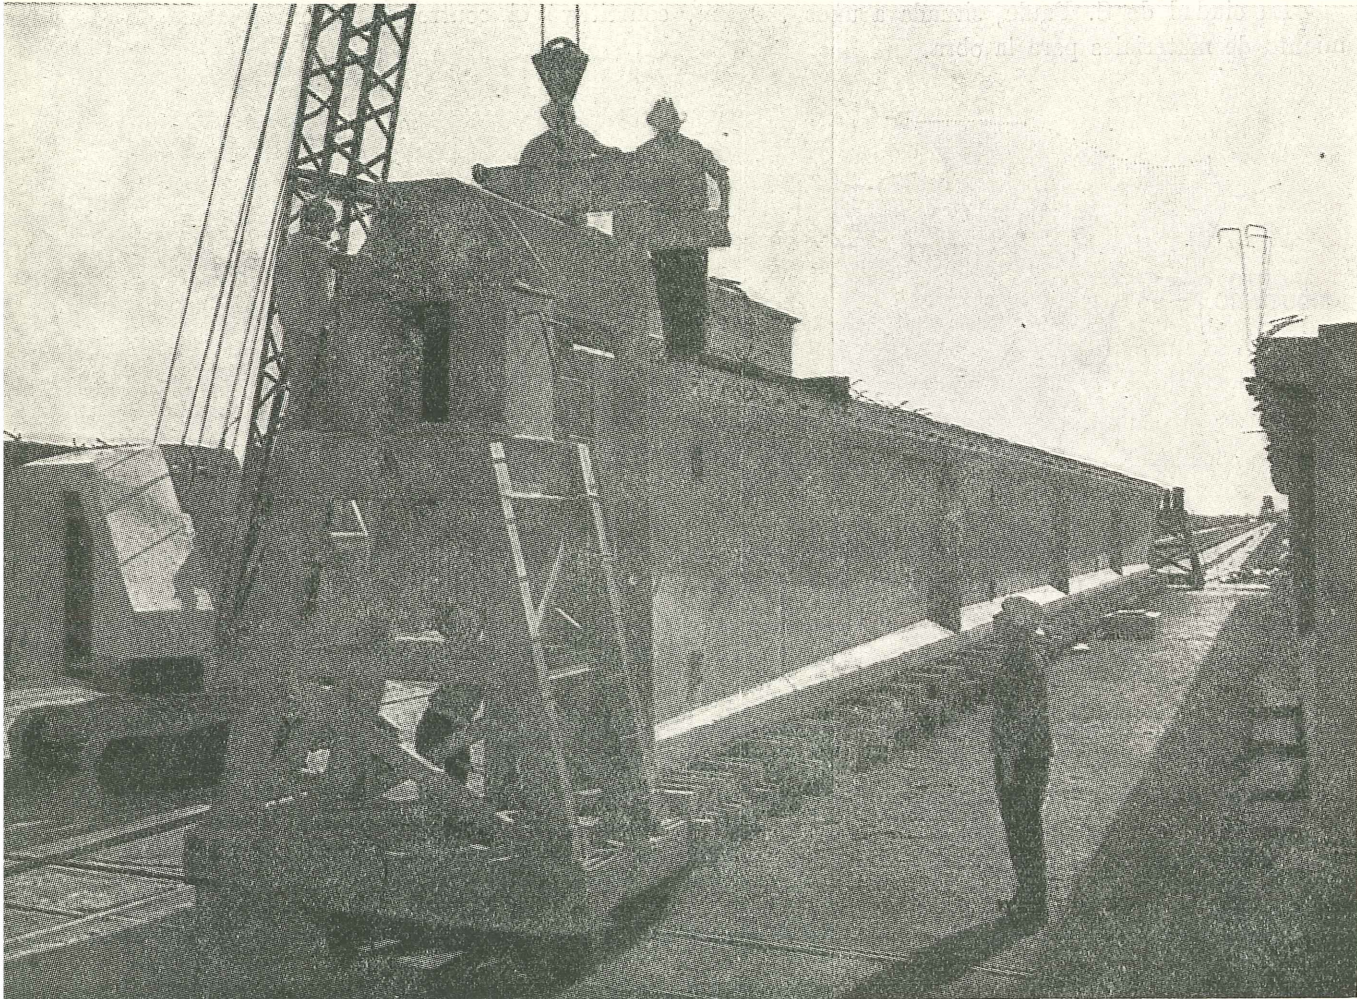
Transporte, desde el taller de prefabricación, de las vigas pretensadas prefabricadas de 45 m de luz; se emplearon para ello carretones sobre los que apoyaban los extremos de las vigas
